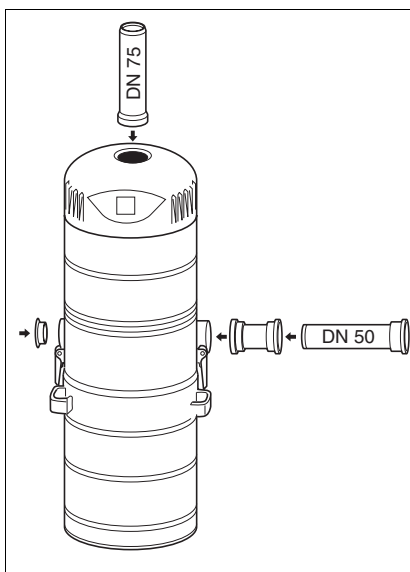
Collegamento del condotto di aspirazione e di scarico dell'aria
